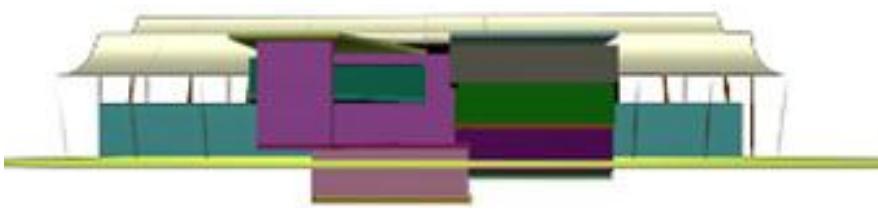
D avec des volumes simples, façade sud du projet avec la tribune en fond.
